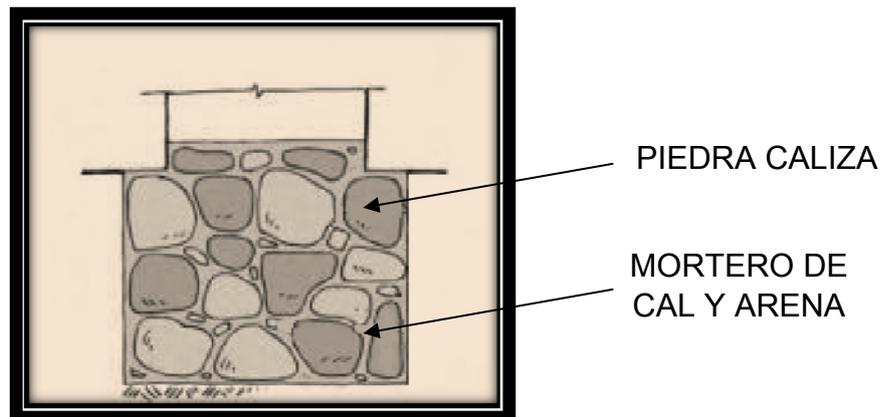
Esquema de cimentación de piedra con mortero de cal
